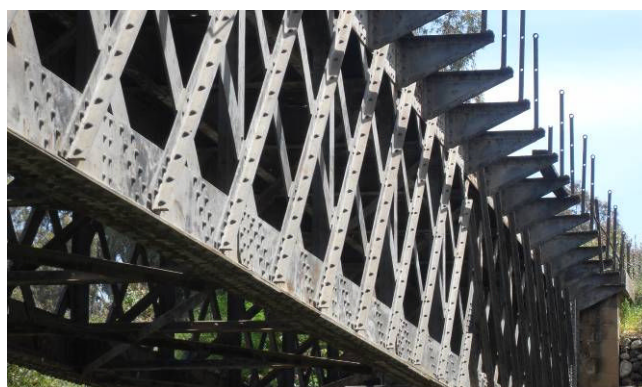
Détail de la travée centrale du pont de Draa Ben Khedda.
